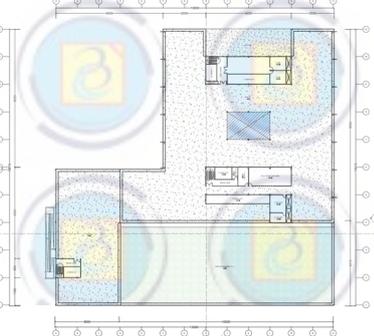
5. Denah Lantai 1 Bangunan RSIA
